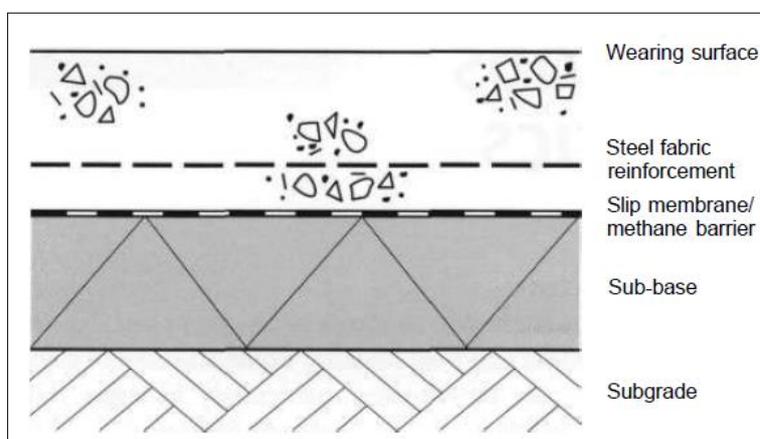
Corte tipo de um pavimento industrial em betão armado [4]
